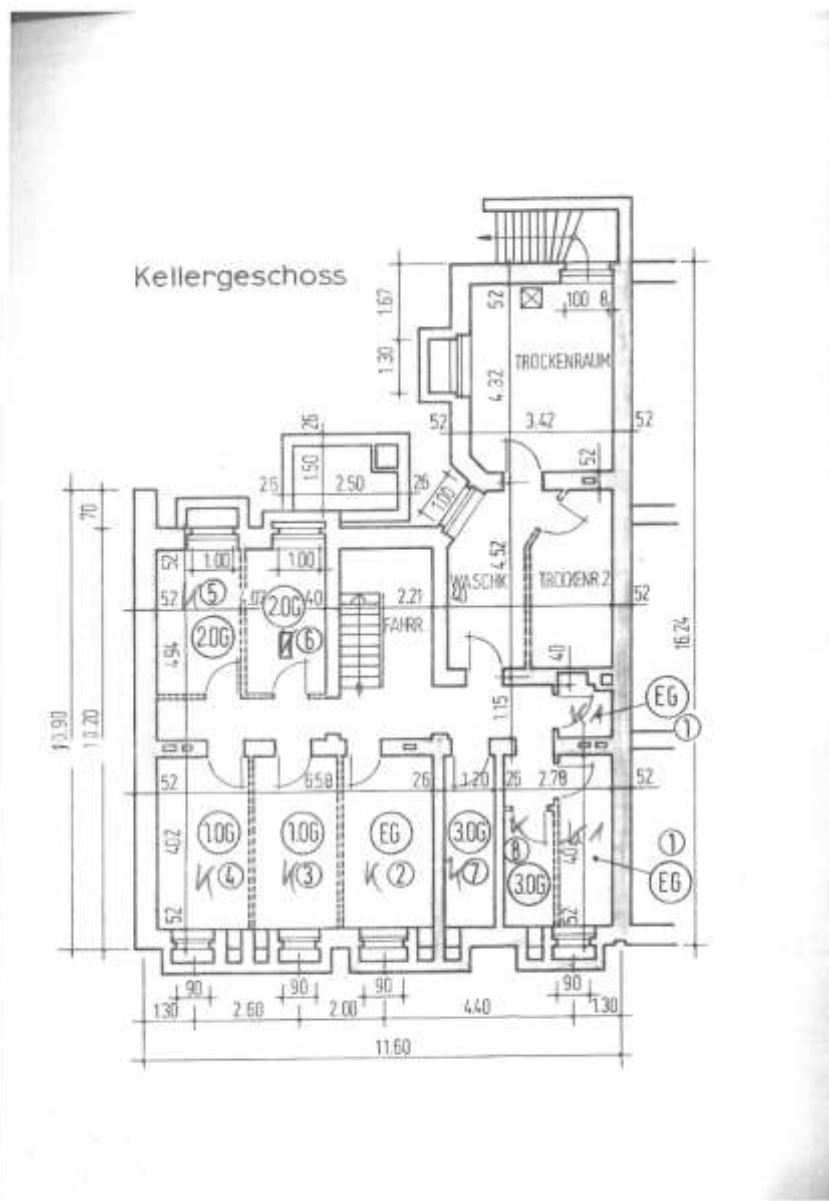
Kellergeschoss Quelle: Grundakte, Teilungserklärung
